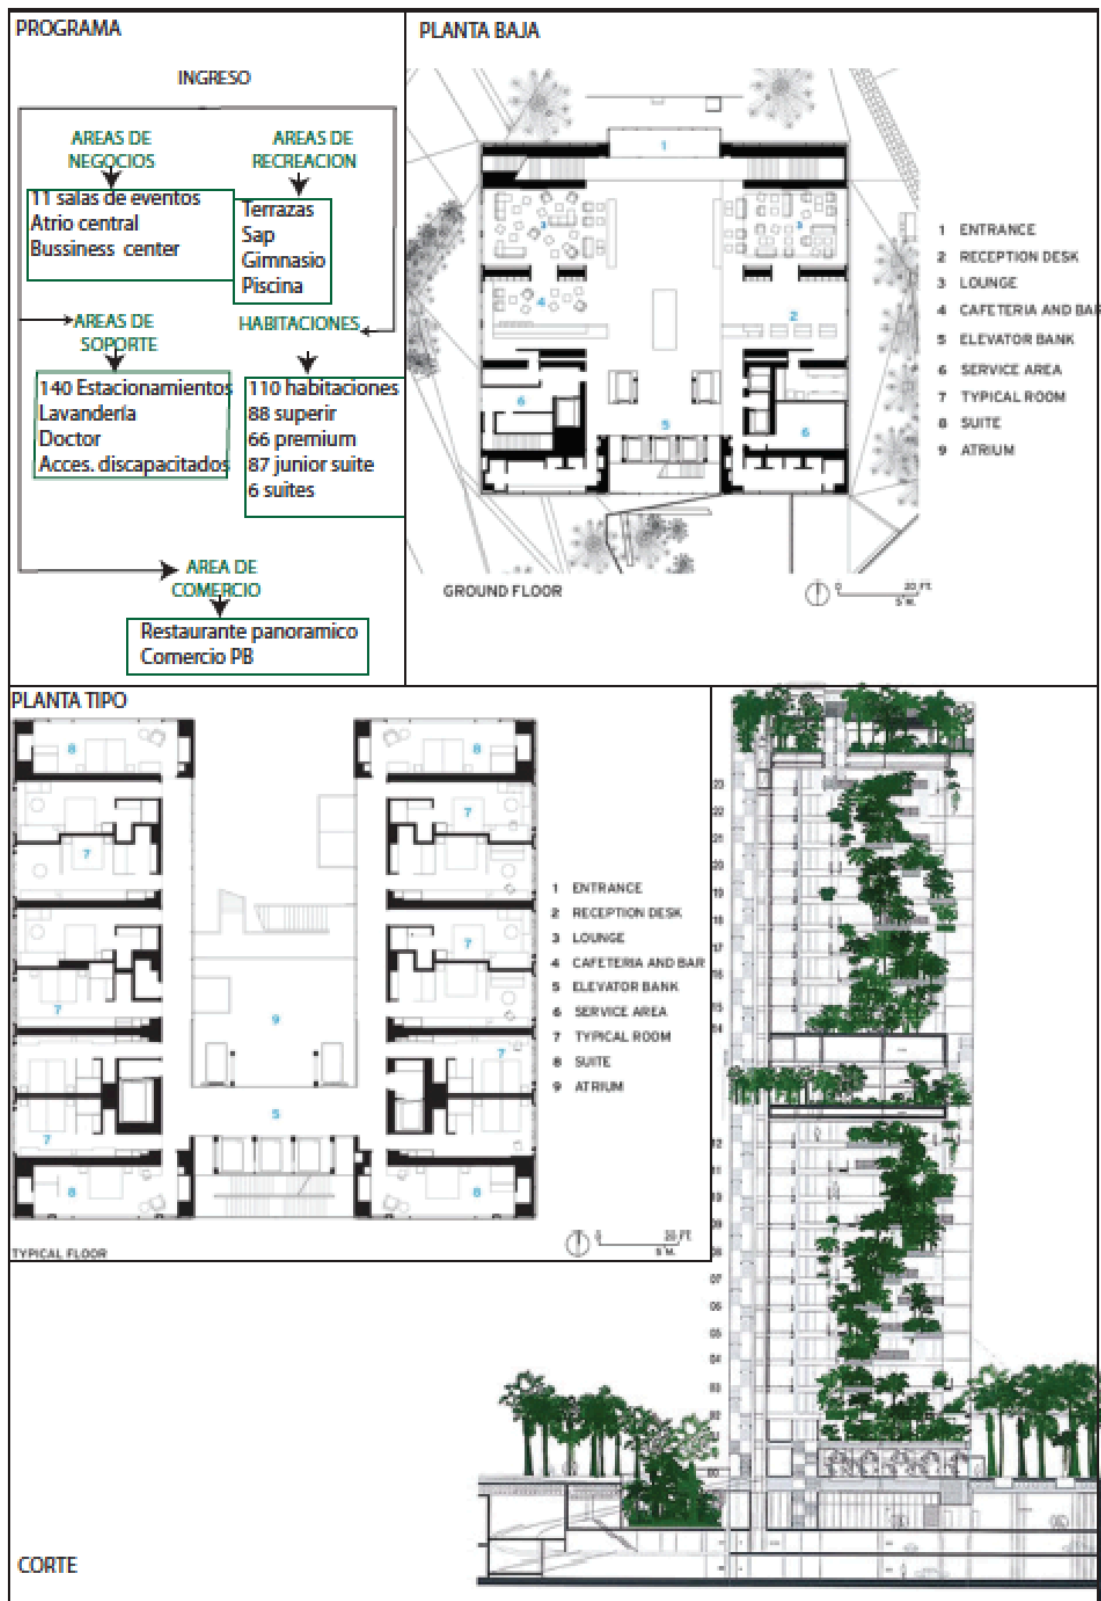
Planos Hotel Renaissance. Recuperado de: http://es.wikiarquitectura.com/index.php/Hotel_Renaissance_Barcelona_Fira
